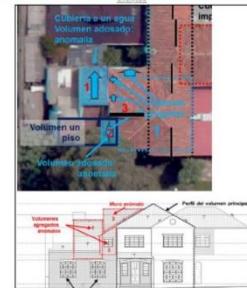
Fachada principal: volúmenes agregados y muro en cubierta, anómalo.
